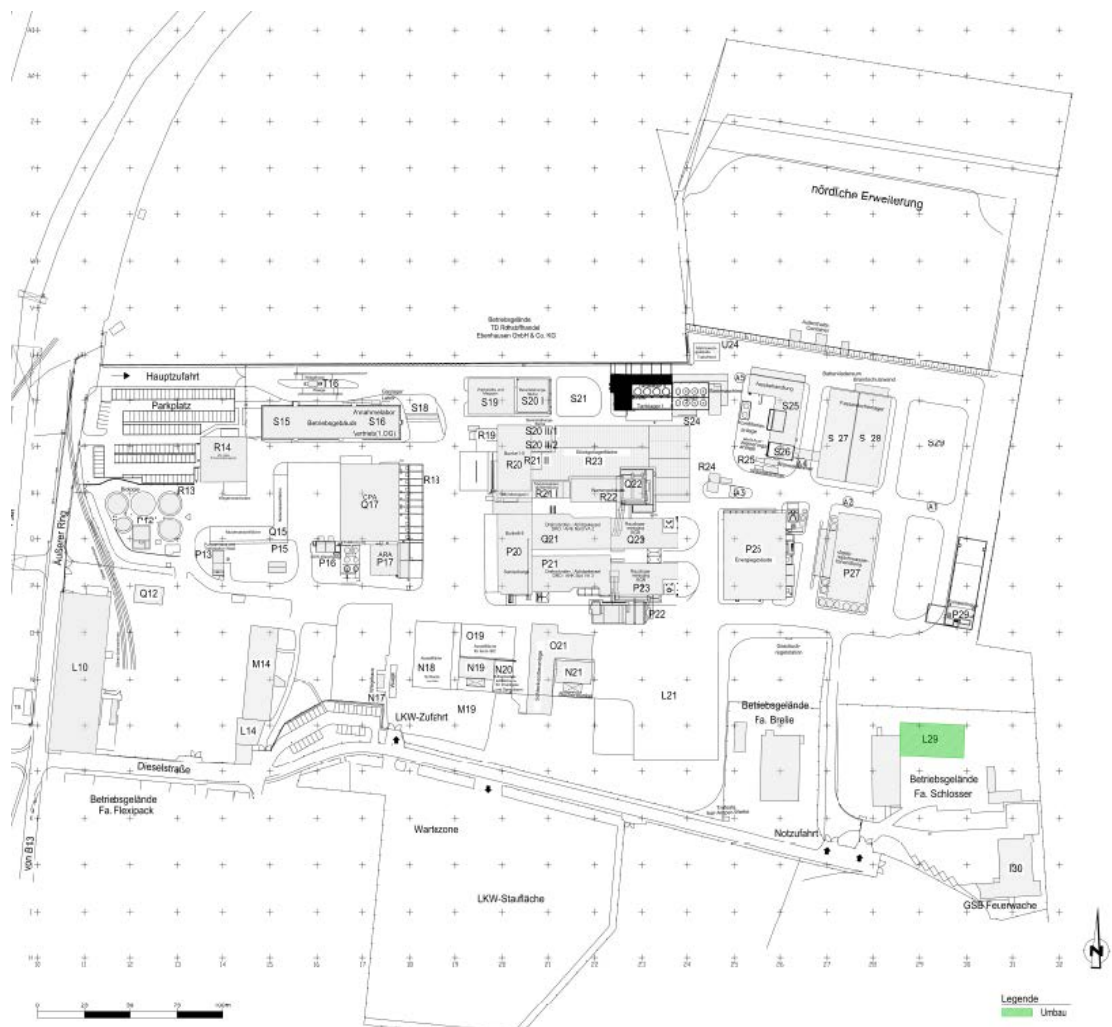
Auszug aus dem Lageplan des Gesamtstandorts; Quelle: Antragsunterlagen [31]. Lagerhalle L29 grün markiert.
